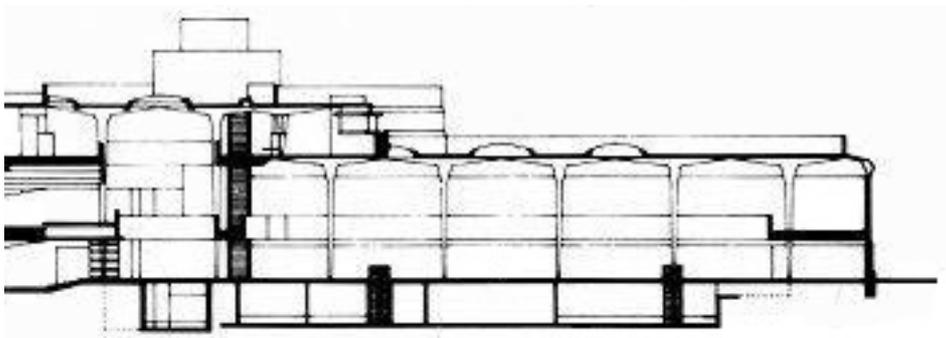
Elevação apresentando o vão central e a cobertura de concreto armado
